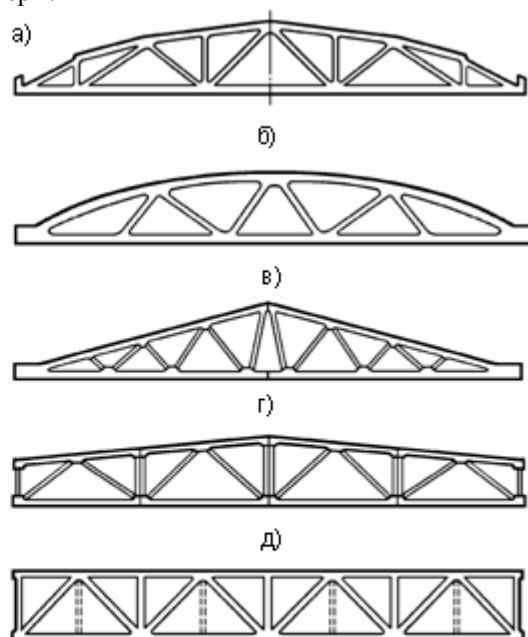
Железобетонные фермы покрытий: а - сегментная, б - арочная, в - треугольная, г - полигональная, д - с параллельными поясами
